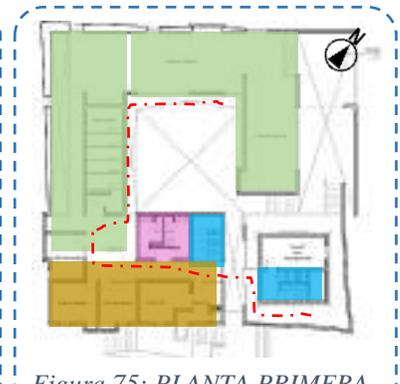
PLANTA PRIMERA, BIBLIOTECA Fuente: ARQA, Propia
